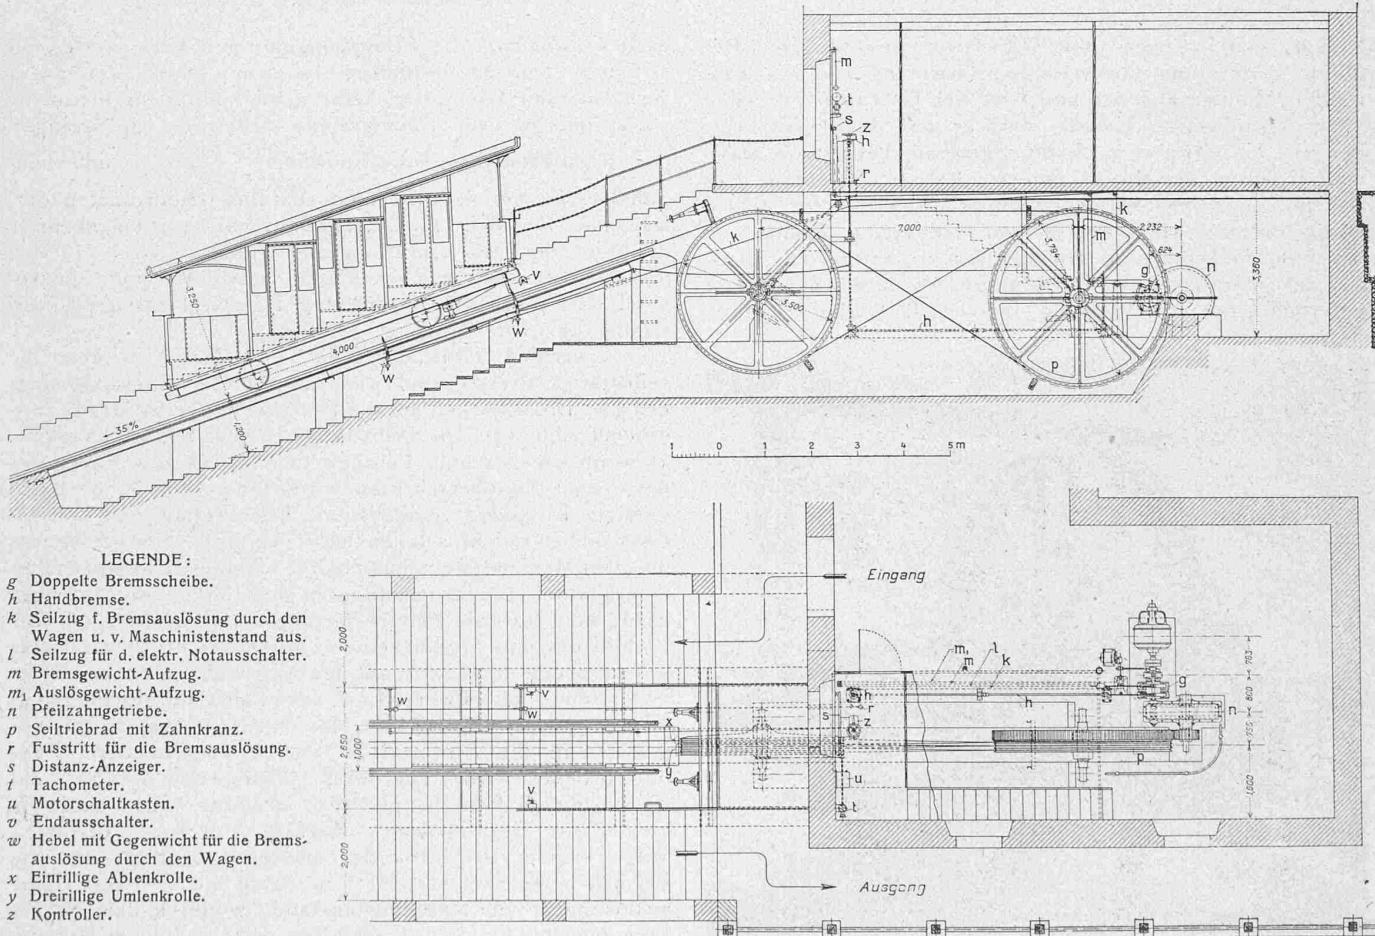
Längsschnitt und Grundriss der oberen Station der Drahtseilbahn Treib-Seelisberg mit Triebwerk. — Masstab 1:150.
